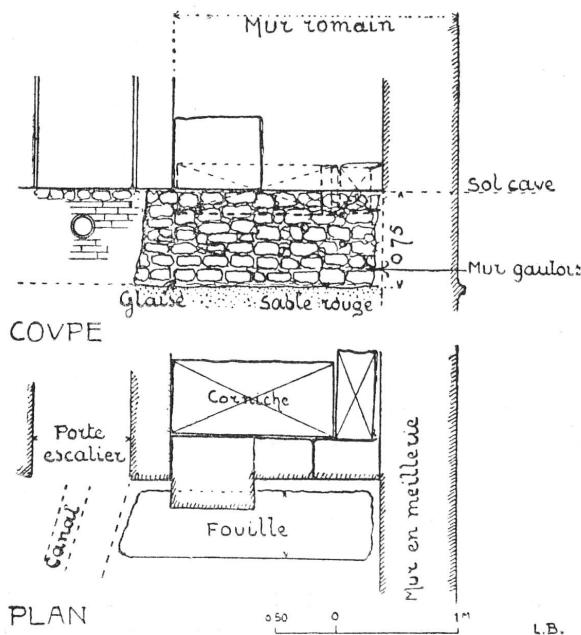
Plan et coupe de la base du mur de l'oppidum.
